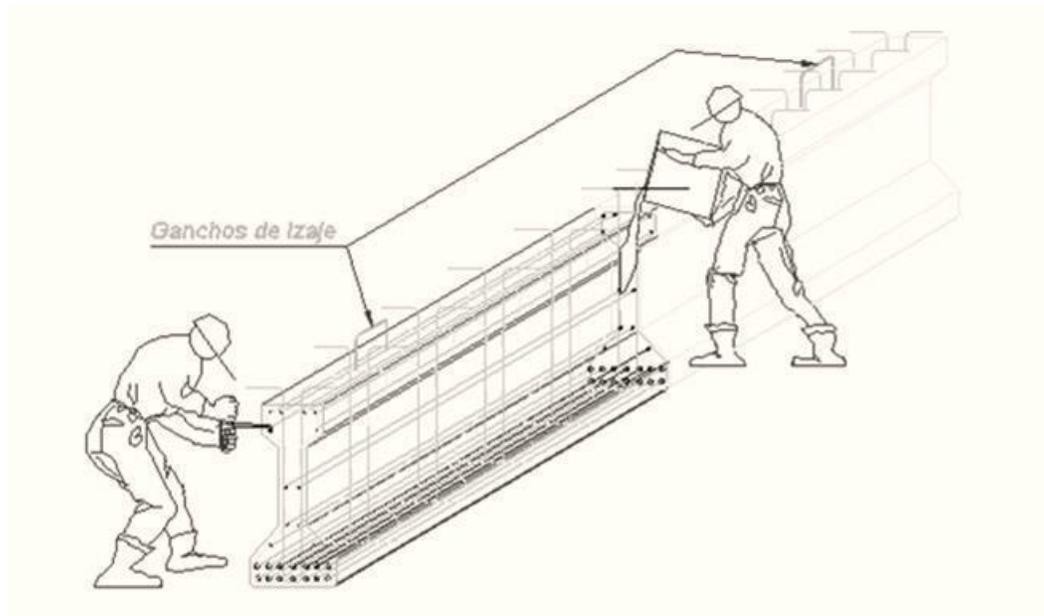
Trazo de la estructura y fabricación de traveses.
